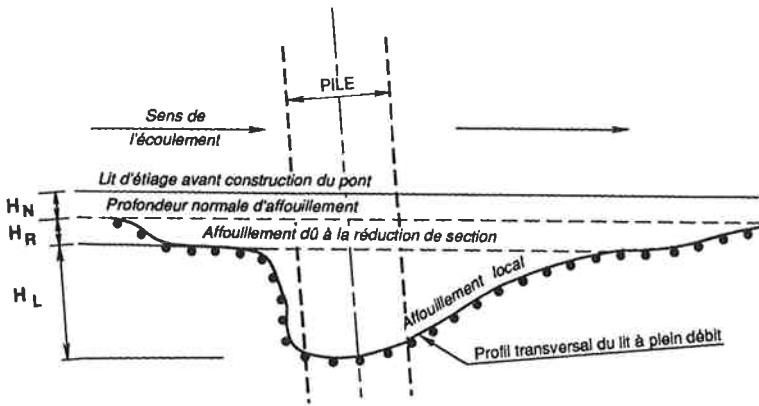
Les trois types d'affouillement au droit d'un ouvrage.
